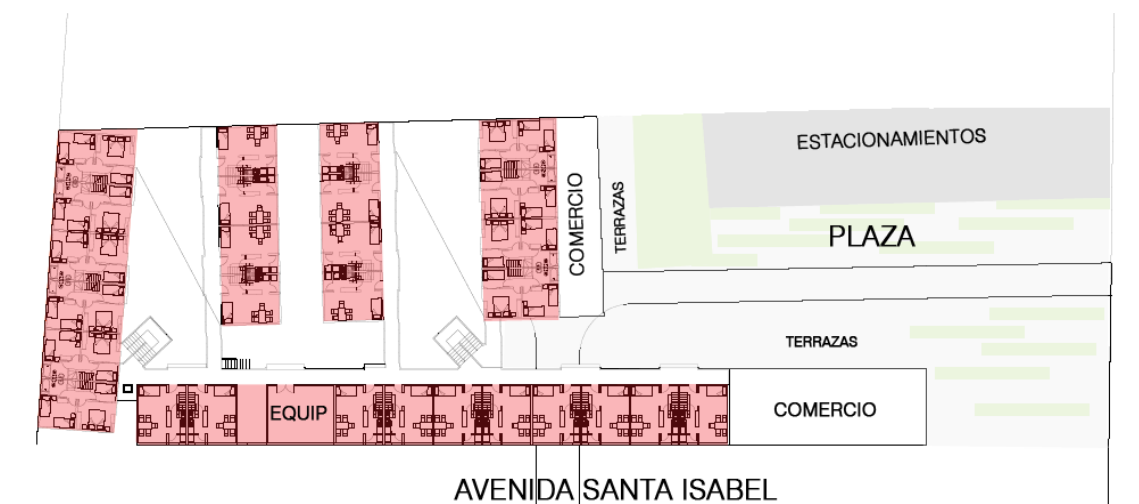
Plano esquemático de partido aproximación a partido general. Fuente: Elaboración propia
